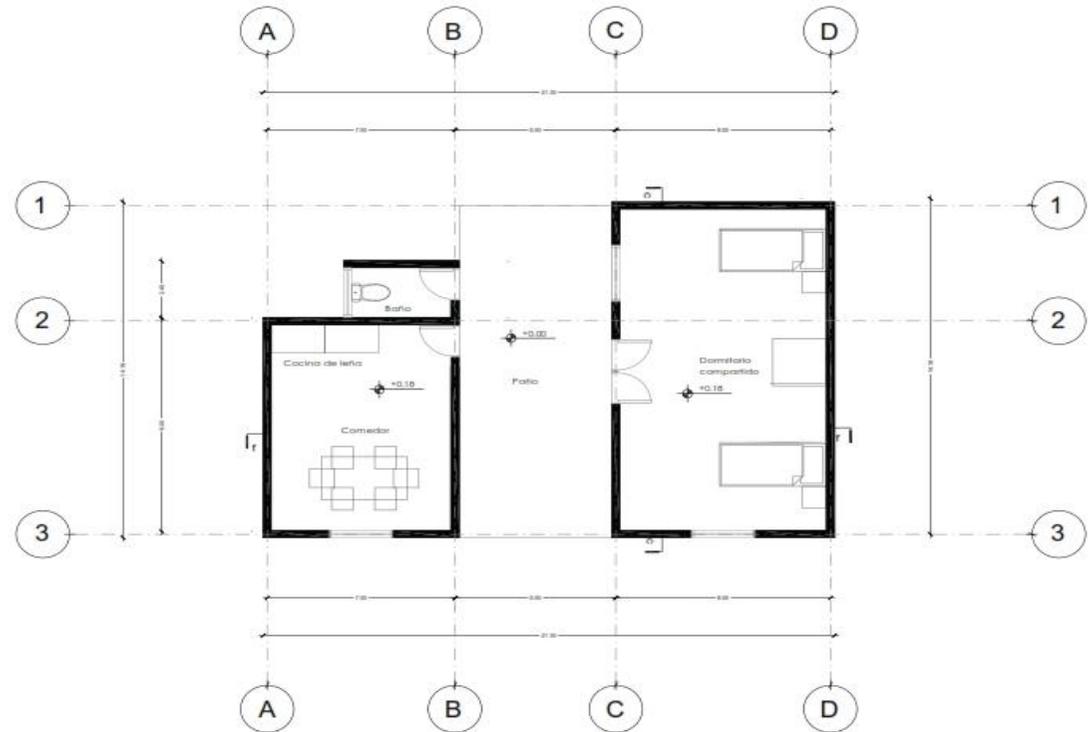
Planta arquitectónica de la vivienda-Caso 2
